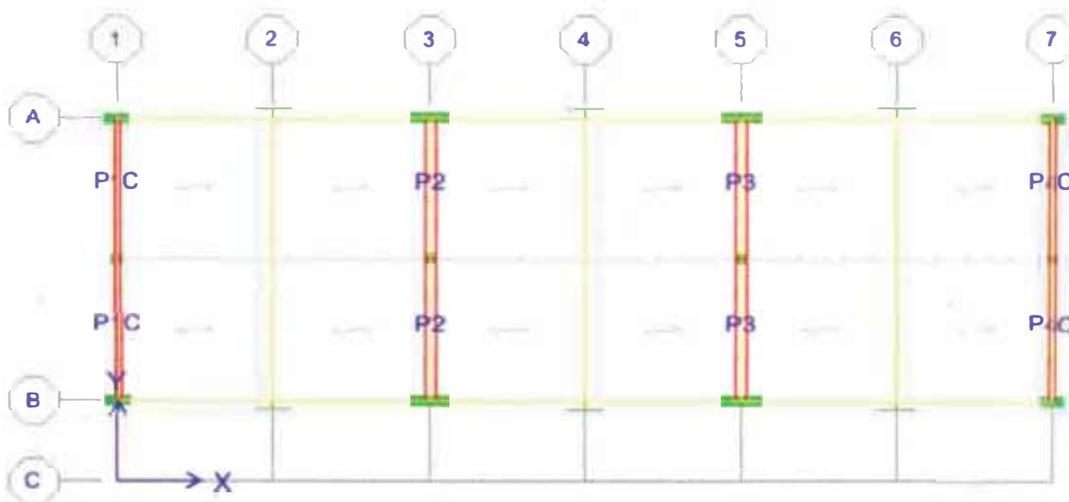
Vista en planta del Módulo 3A-3P con muros exteriores de concreto (P1C y P4C).
